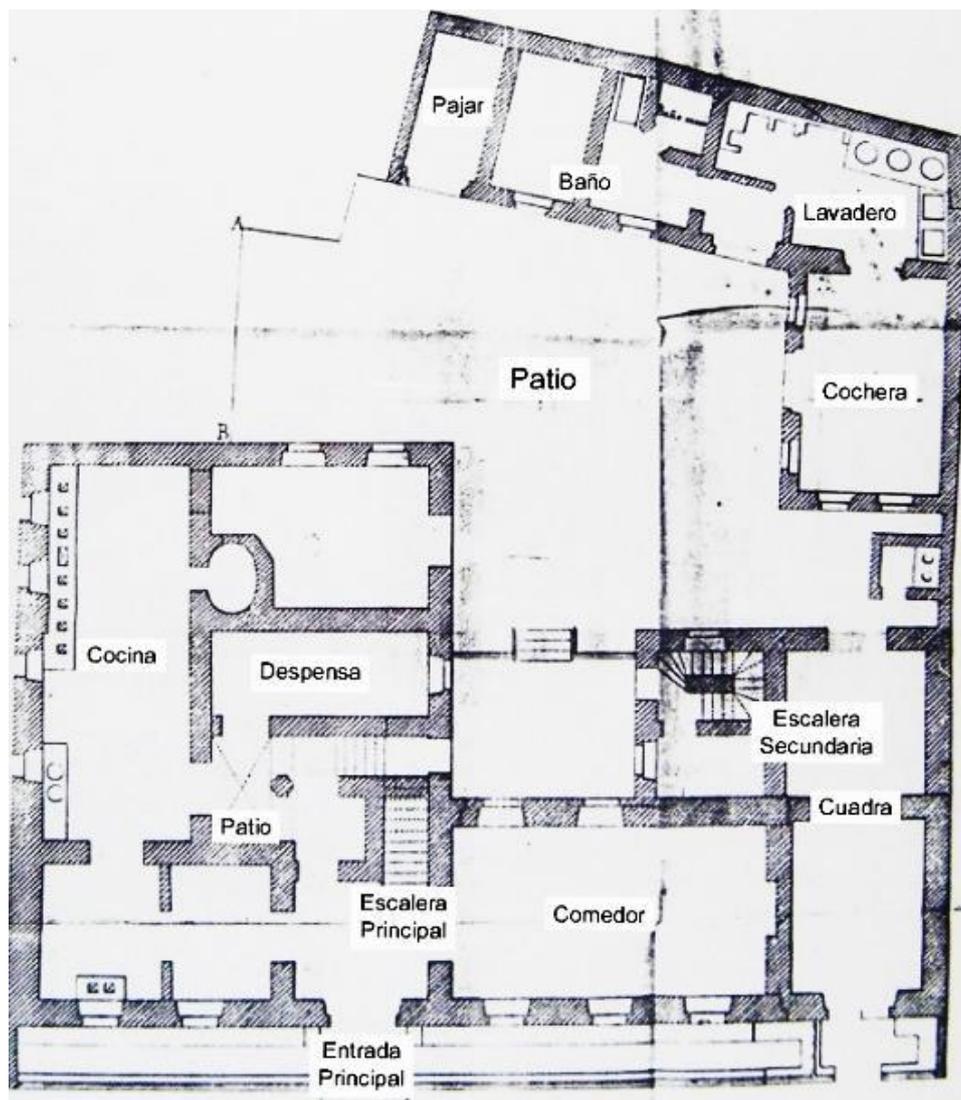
Plano de la planta baja de la legación de Suecia, Álvaro Rossell (ADT, Caja 538)
